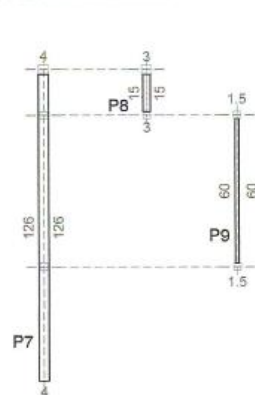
Plano de arquitectura (Tipo 2 Vallas peatonales)
